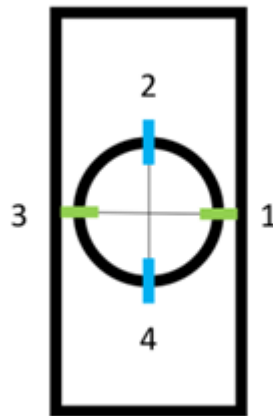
Vista em perfil da viga e esquema da colocação dos extensómetros.
